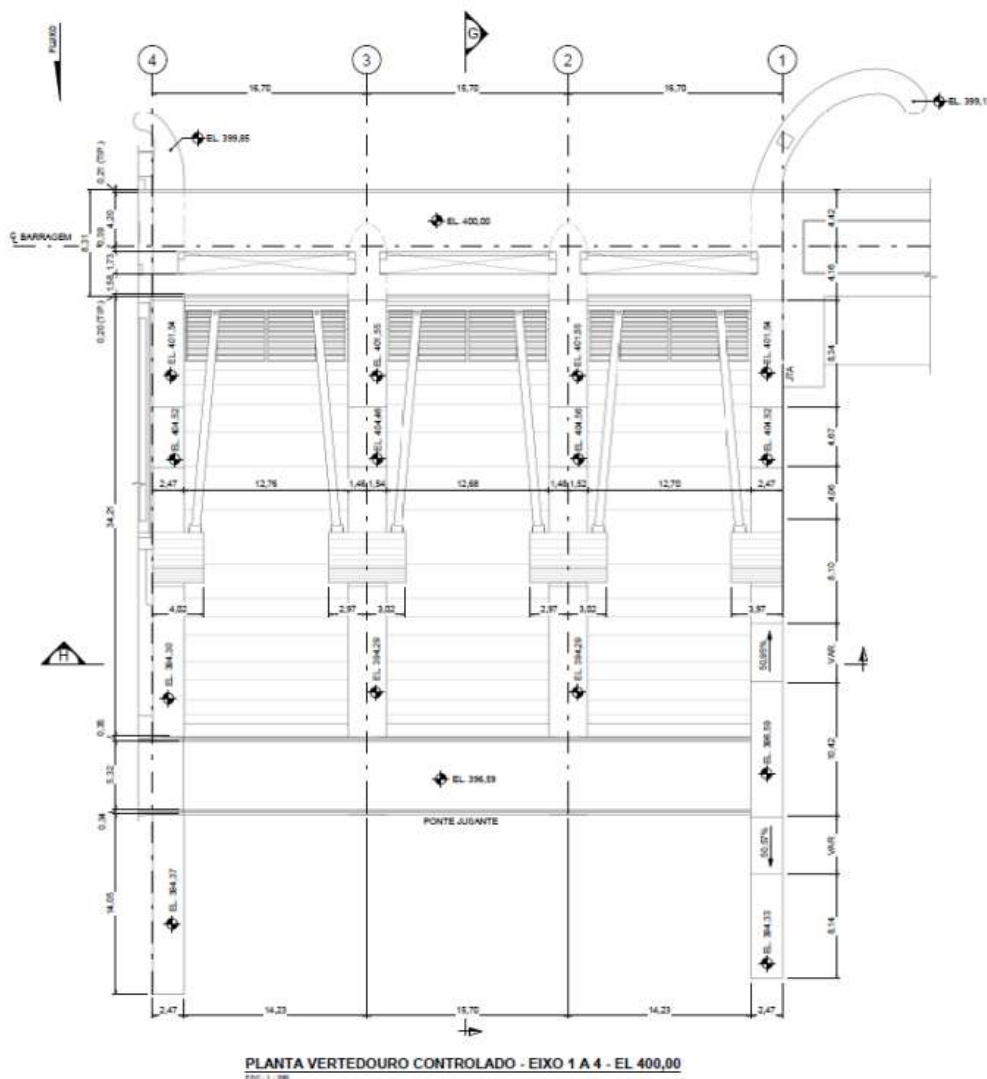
Planta do Vertedouro Controlado da UHE Ourinhos.
